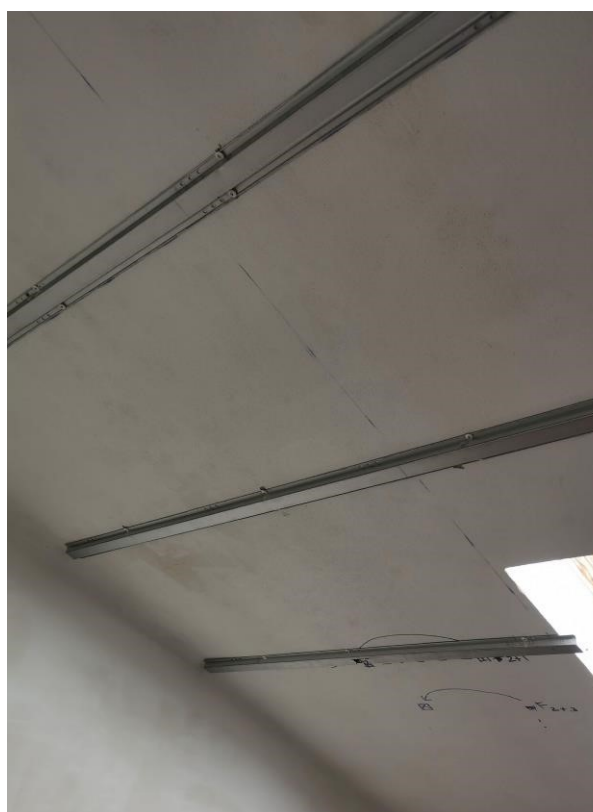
Fotografia da aplicação do perfil metálico no telhado do caso de estudo em Coimbra.
